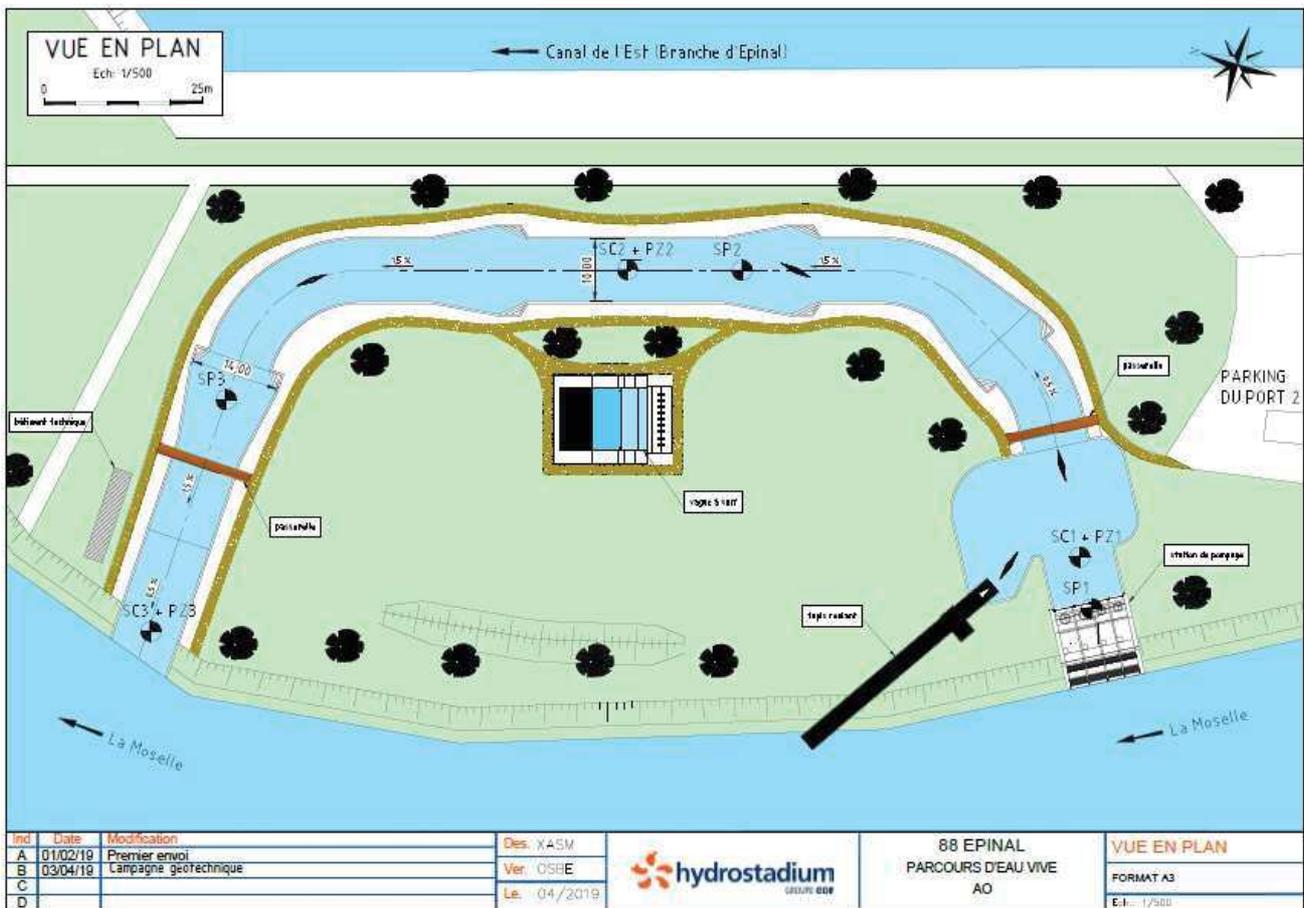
Plan d'aménagement (source : HYDROSTADIUM)
